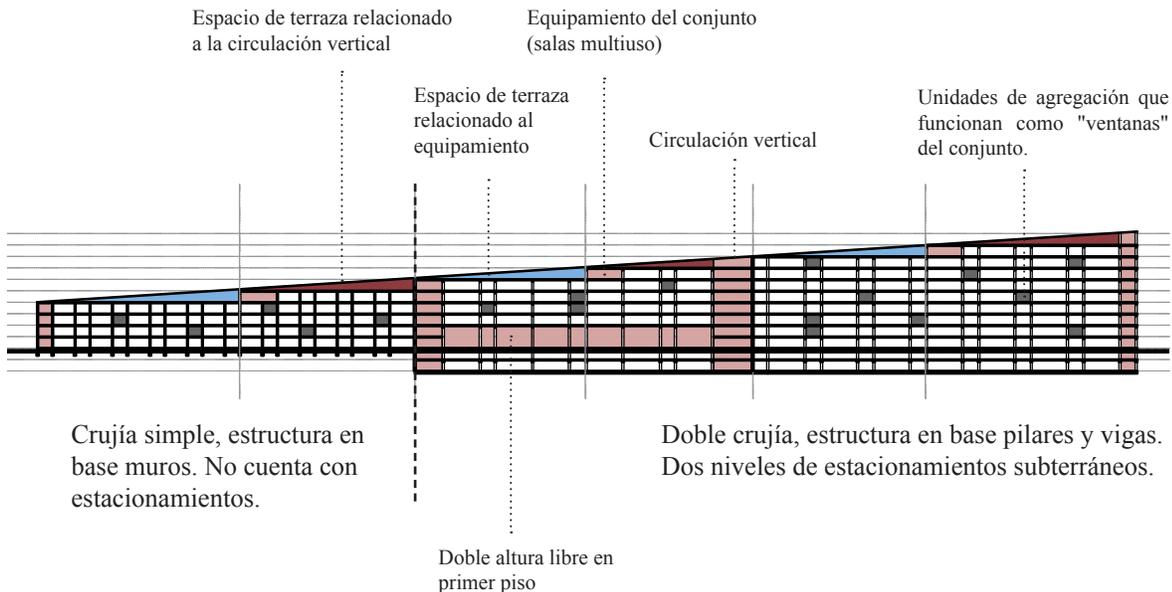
, Esquema de estructura. Fuente: Elaboración propia.
